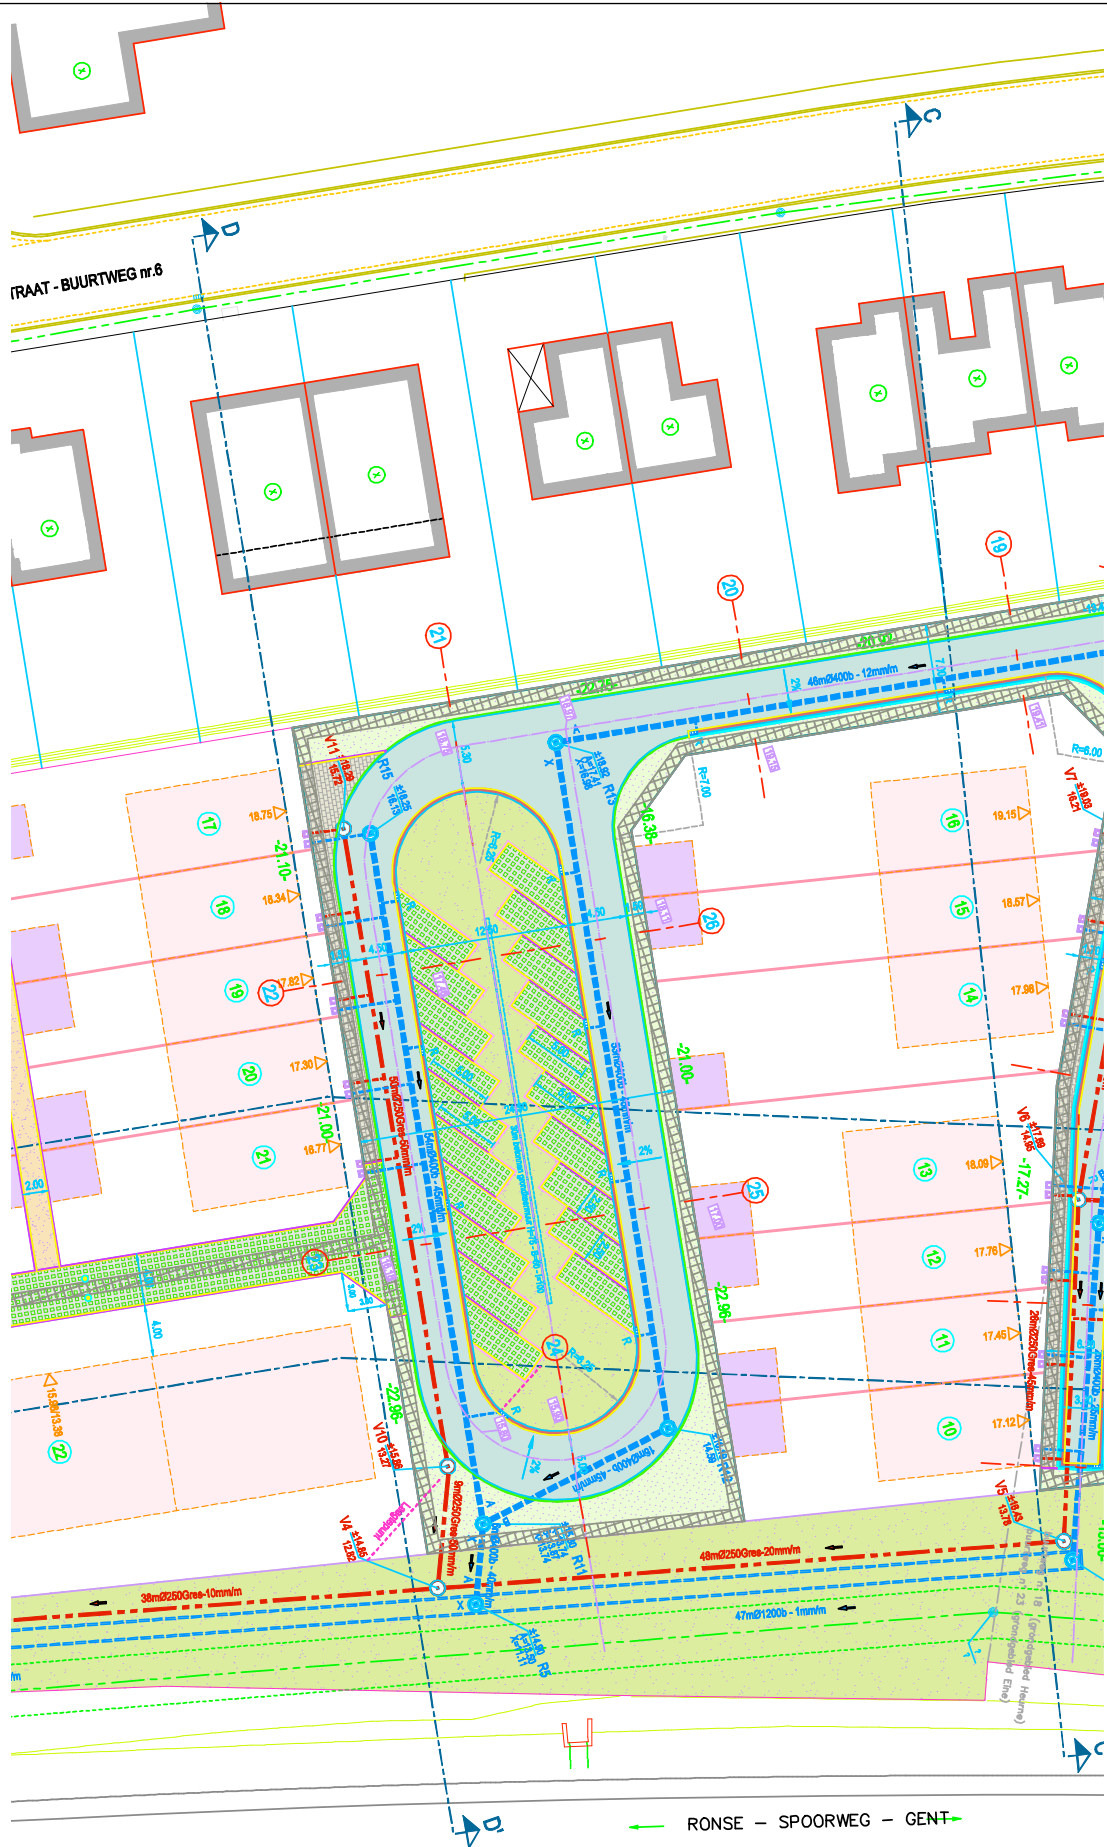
Detail van het noordelijk deel van het ontwerp met zicht op de locatie van doorsnedes 11-18 (© Studiebureau Steven Buyens)
